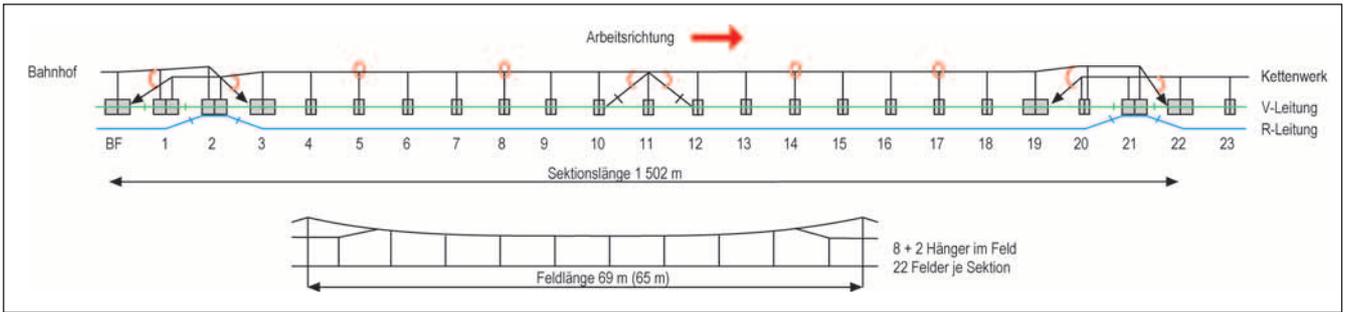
Lageplan des Musterabspannabschnittes einer Oberleitungsanlage.
